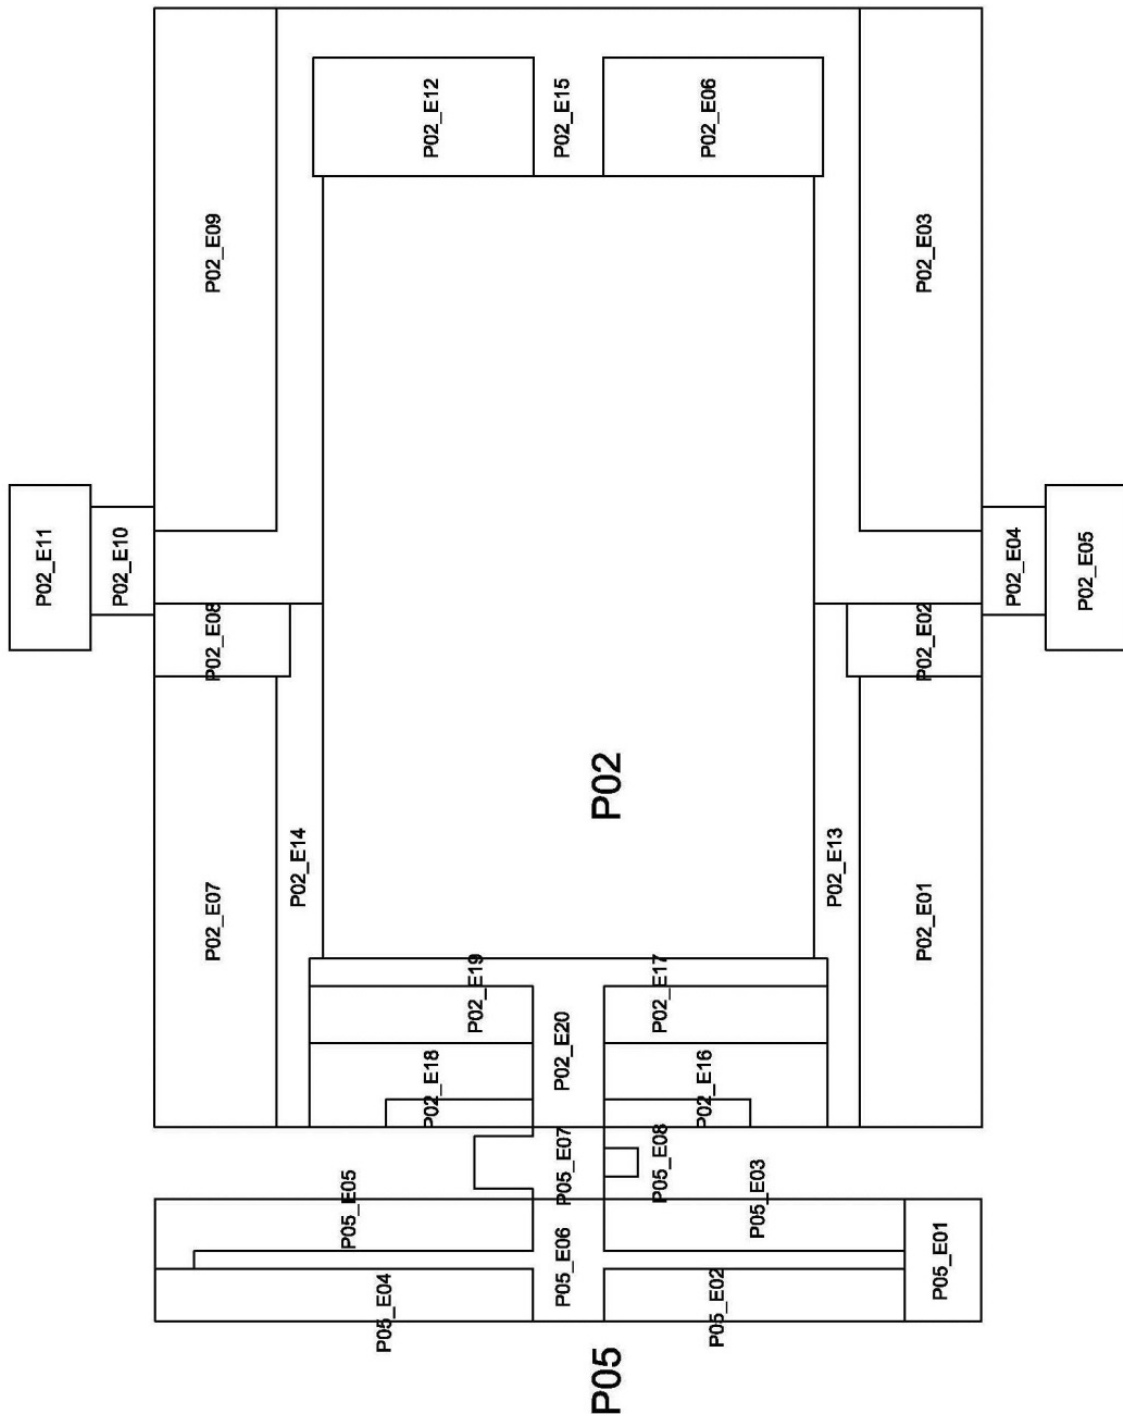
Distribución en planta de los espacios de las plantas P02 y P05.
